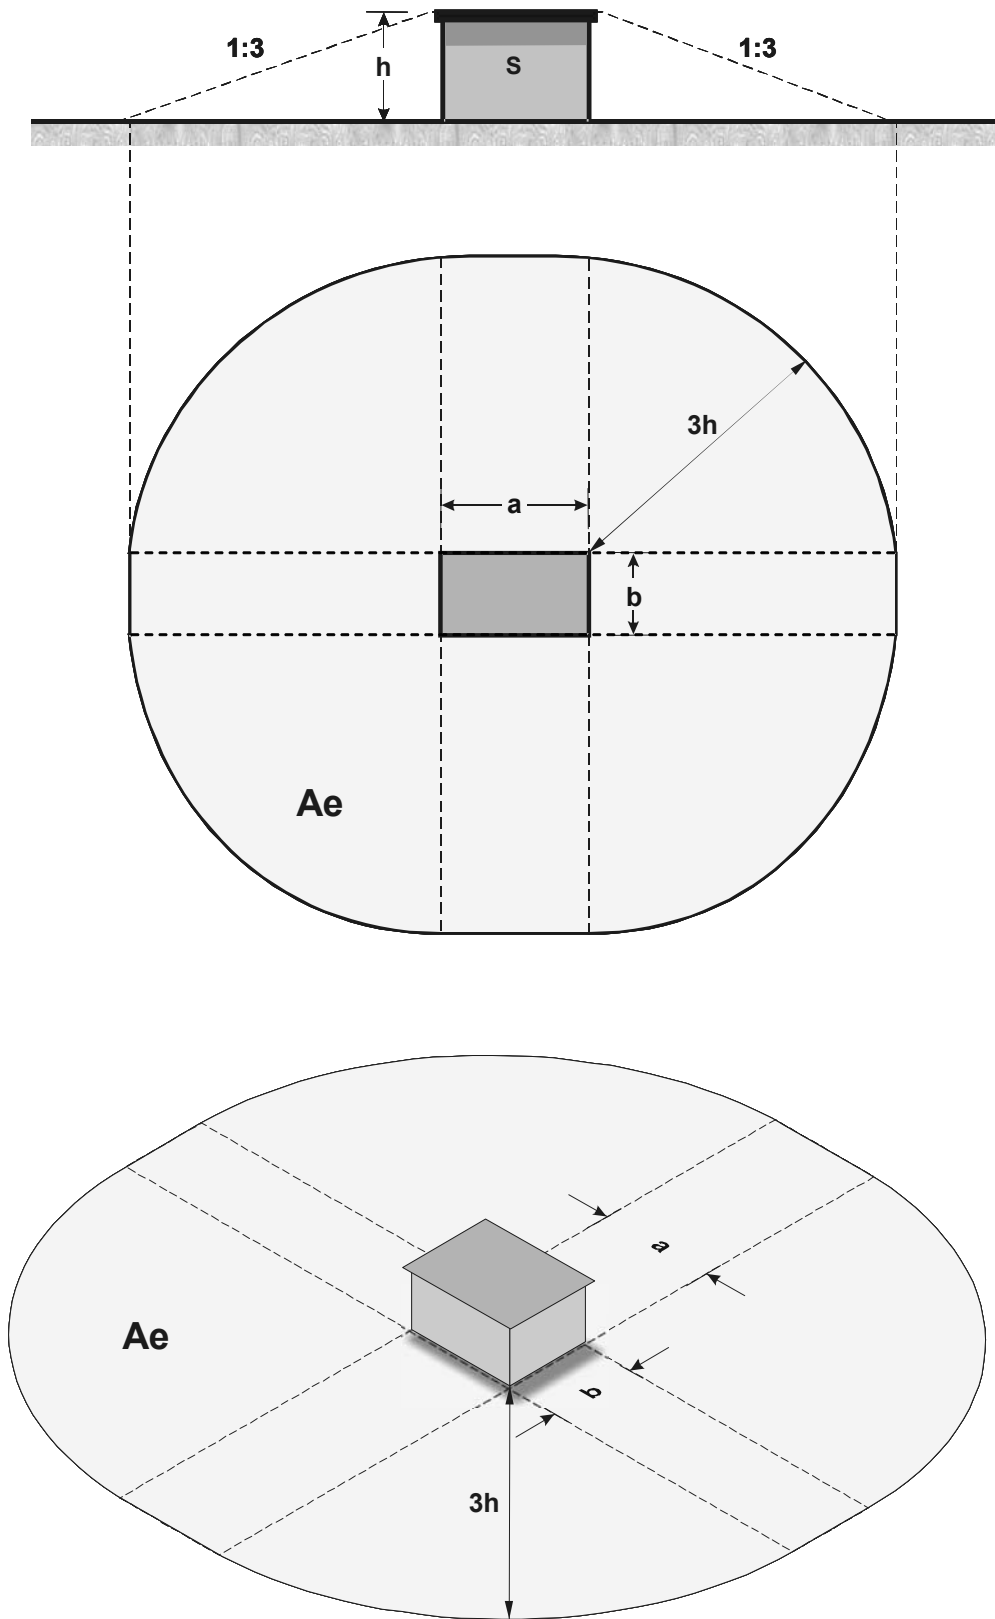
Área de captura equivalente para una estructura con techo plano y terreno plano
